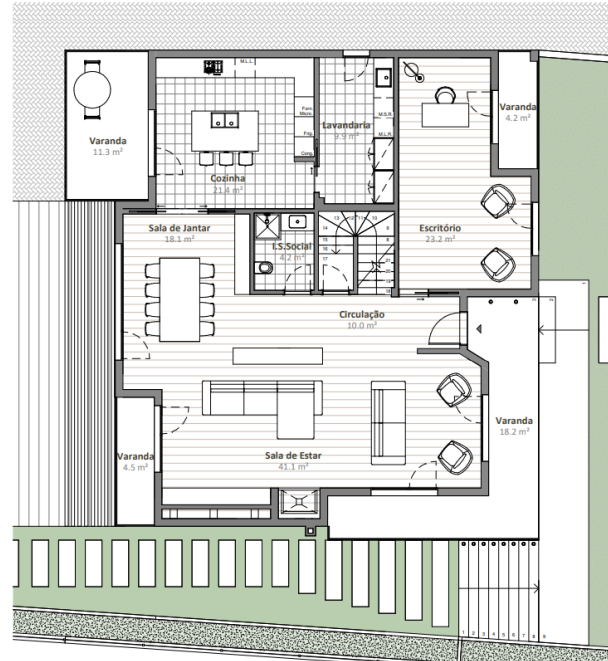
Proposto - Planta do piso 0 (EP_R00).
